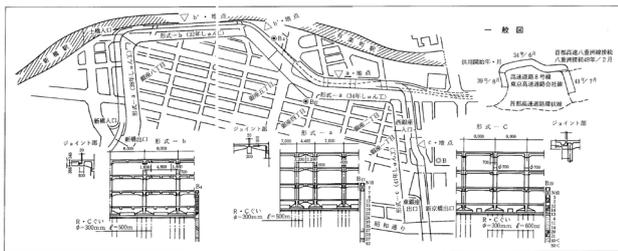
東京高速道路 平面図及び構造断面図⁴³⁾
